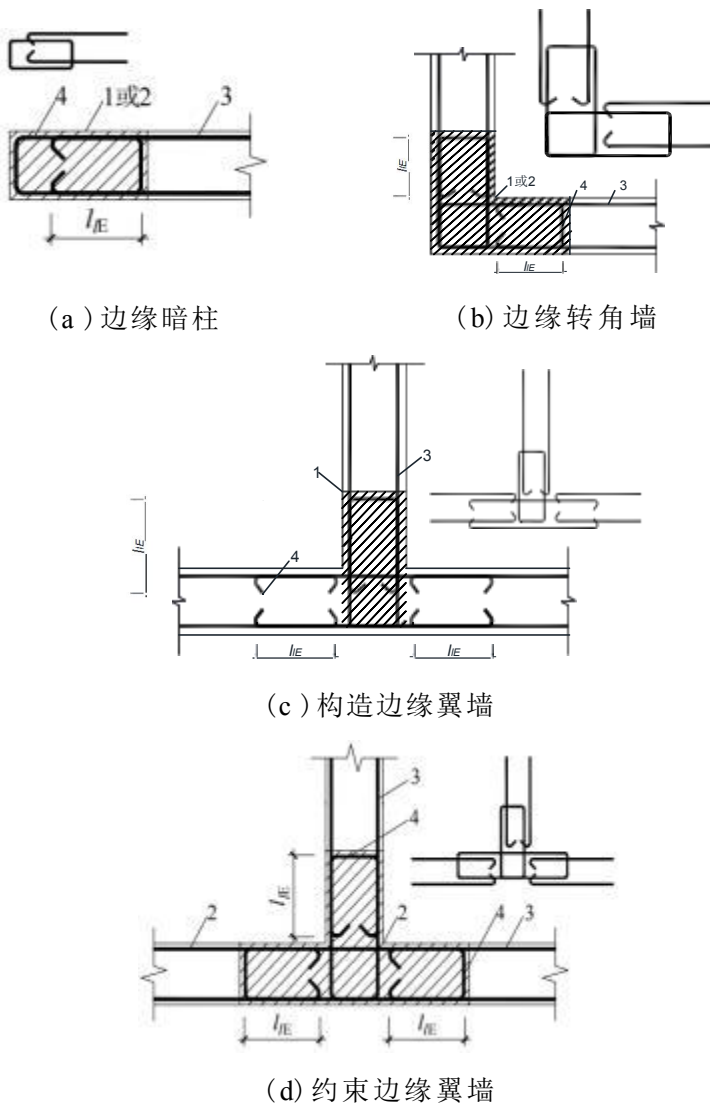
M 型钢骨架剪力墙结构端部、洞口两侧及纵横墙交接处墙体水平钢筋构造示意
